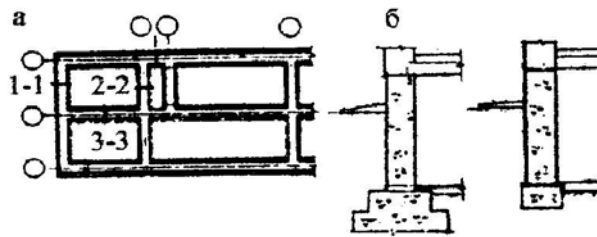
Монолітні стрічкові фундаменти: а – план; б – розрізи
